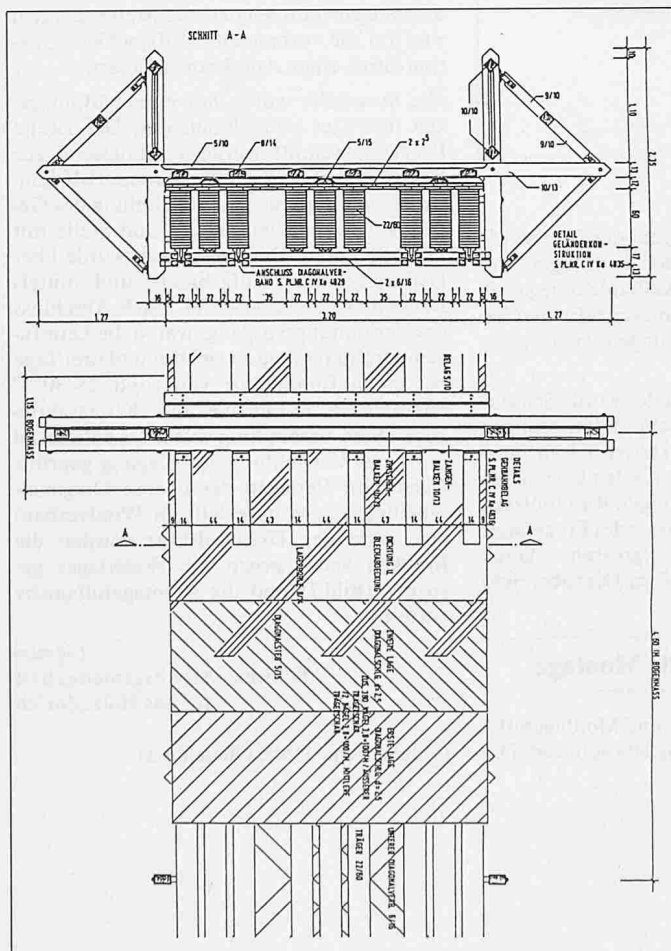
Schnitt und Aufsicht auf die Spannband-Konstruktion mit Brückengeländer
